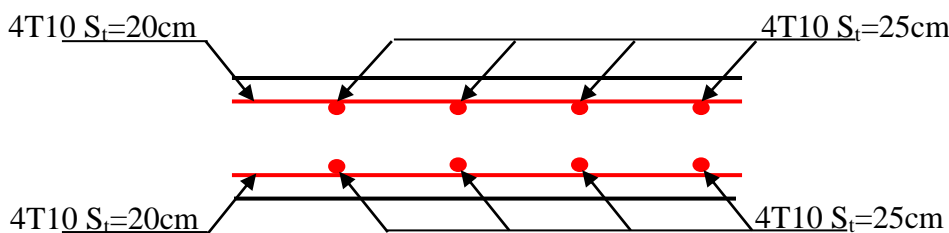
Vue en coupe A-A du ferrailage de la dalle.
